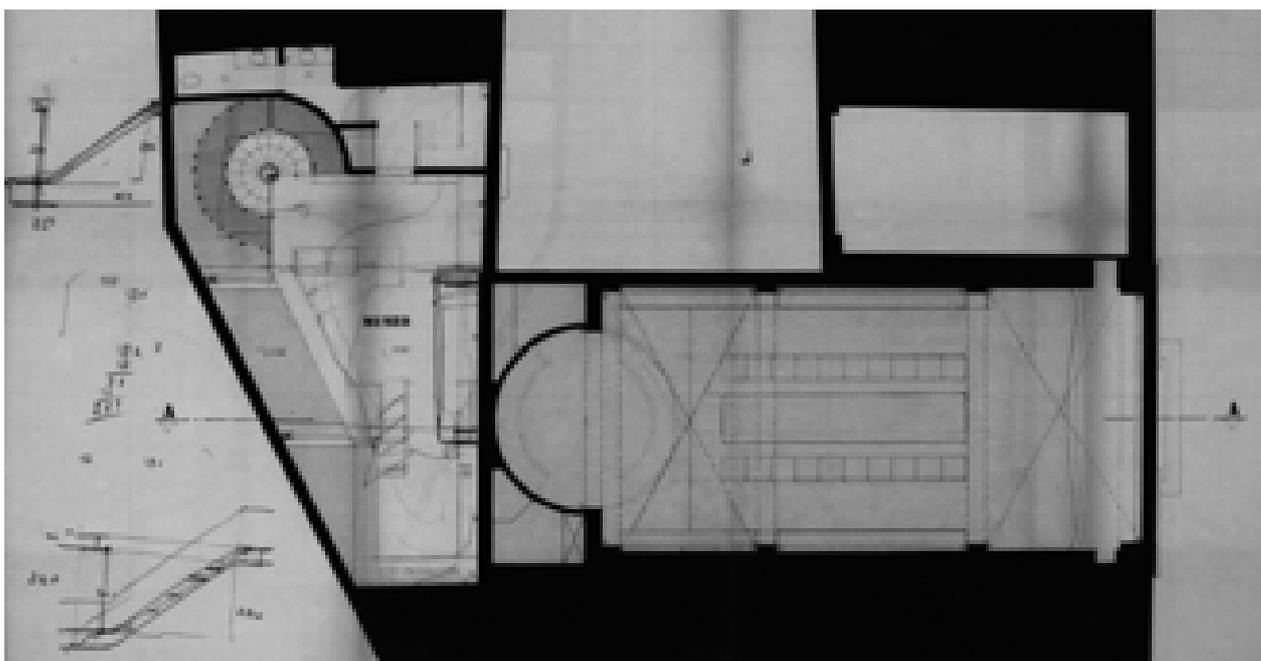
Pianta doppio volume– Stato di progetto – 10/11/1980 (AABS-94.050)
